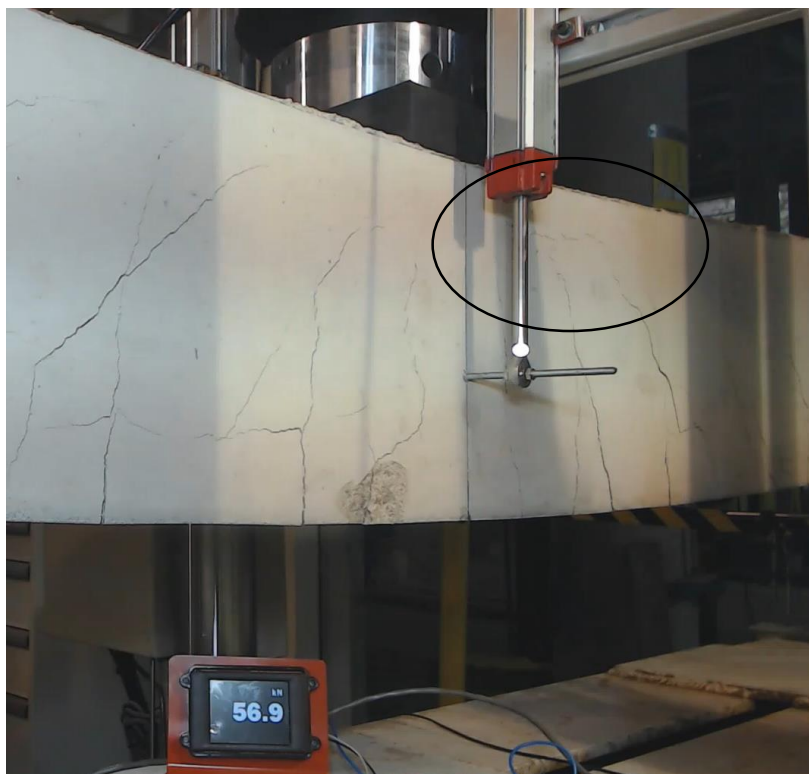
Fisuras Viga 2V13 a 56,9 kN, Grupo 1.
